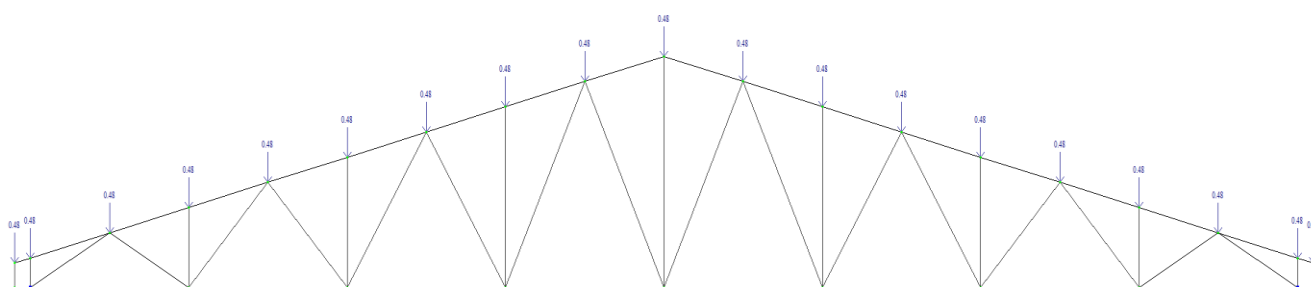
Схема навантаження ваги конструкції покрівлі (загрузка 2)
